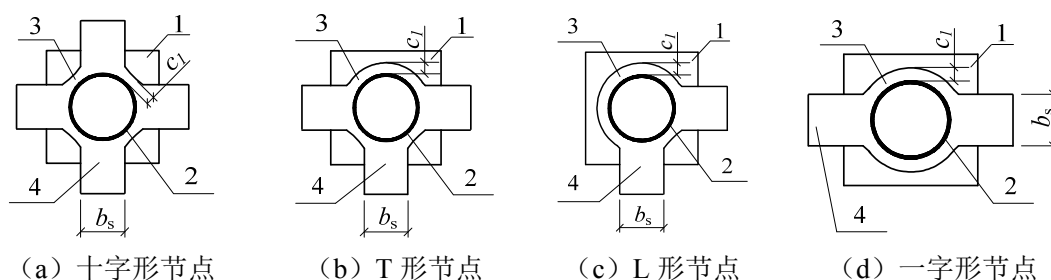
钢筋混凝土梁与叠合柱采用带外伸钢板的外加强环连接示意图
